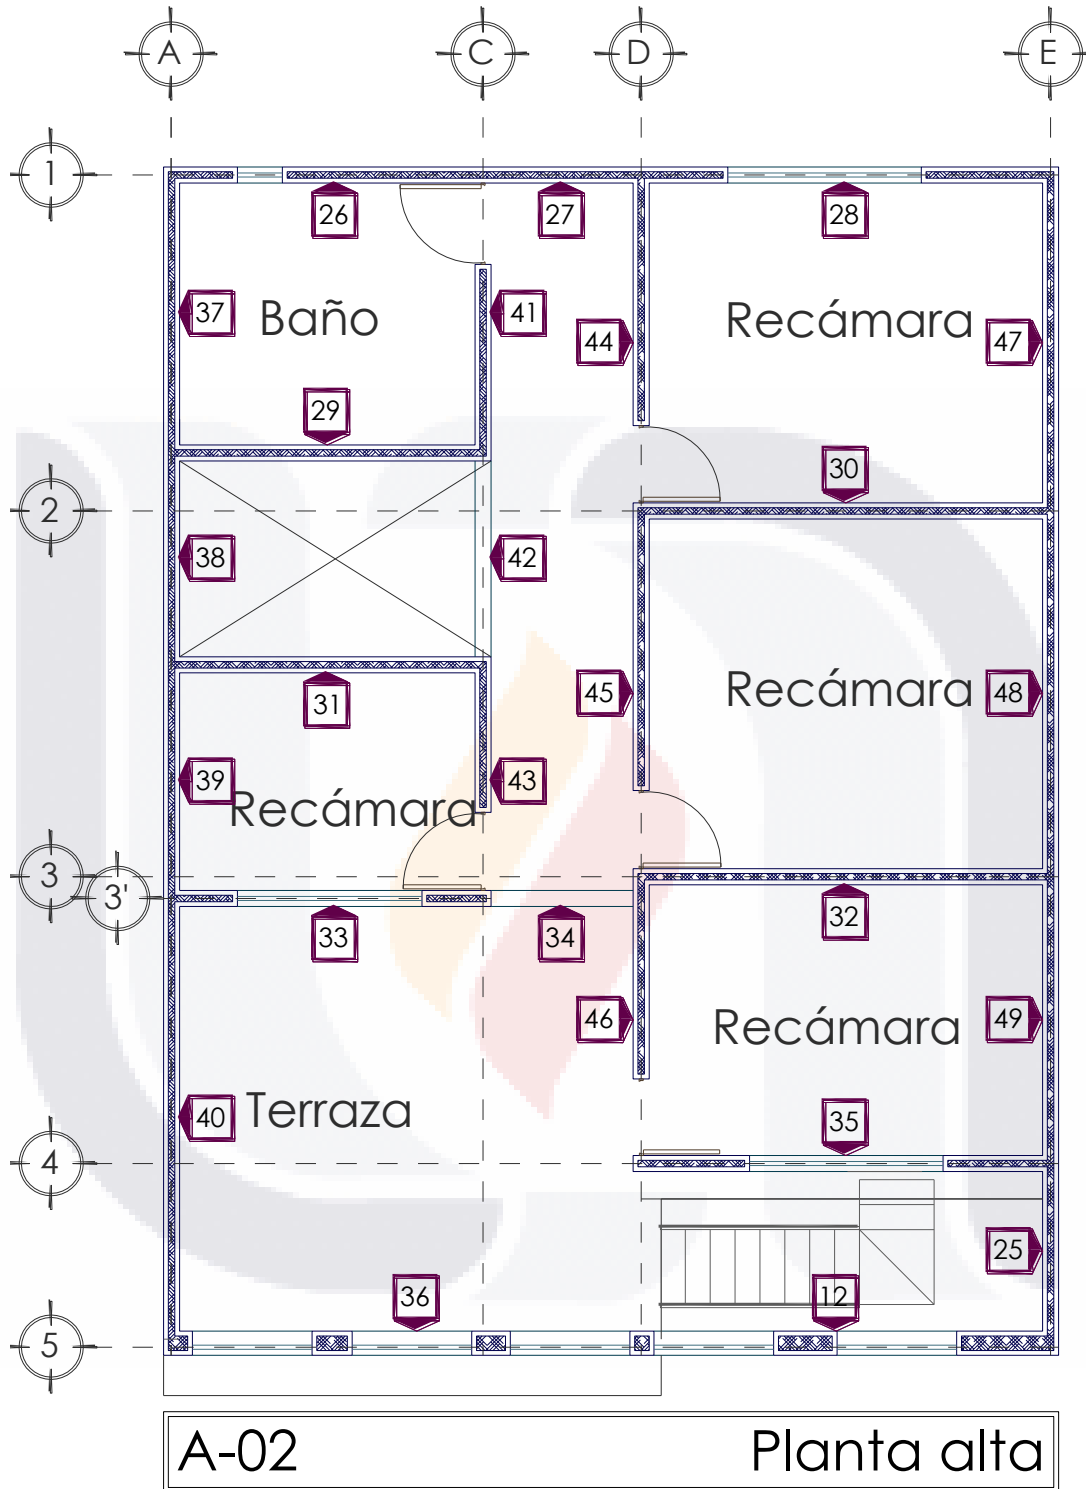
Caras de muros consideradas en el análisis. Planta Alta
